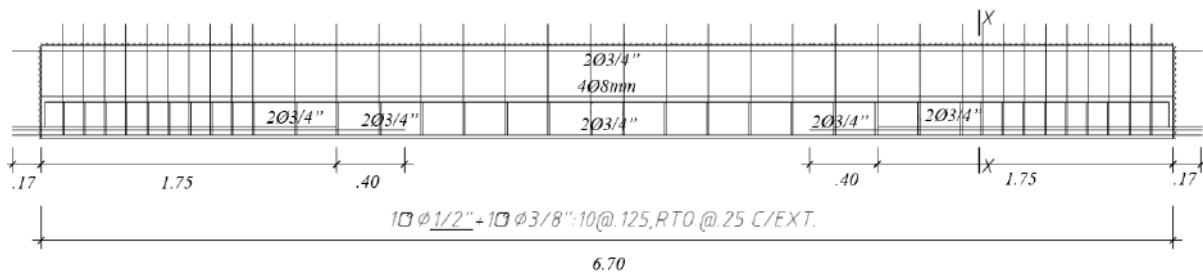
Desarrollo de la viga JT55 Tipo 1.
